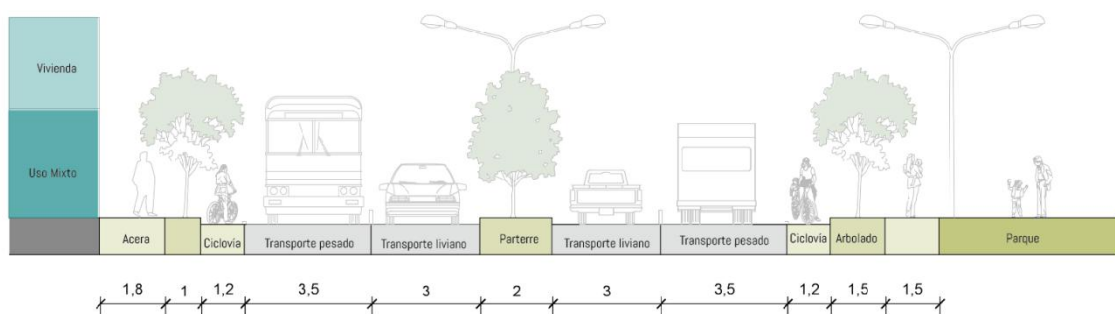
Sección de vía longitudinal principal. Fuente: Elaboración propia.
